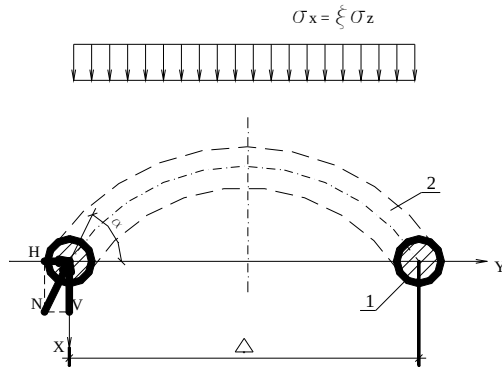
Расчетная схема арочного свода, возникающего в грунте между армоэлементами: 1 — армоэлементы; 2 — грунтовый свод
